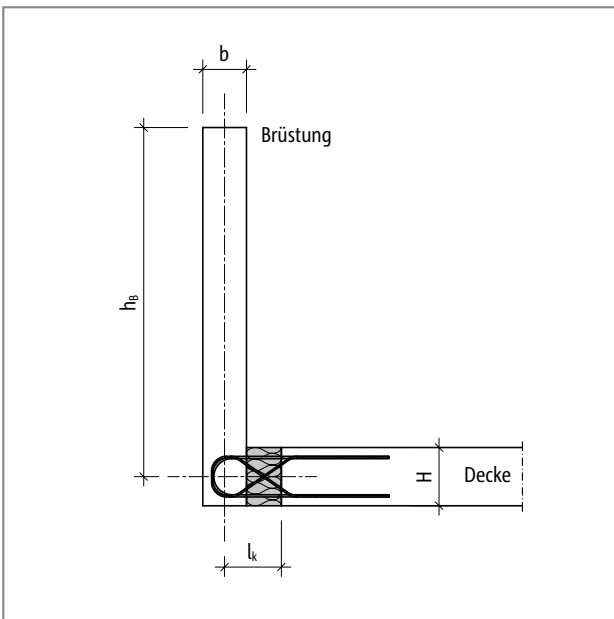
Schöck Isokorb® T Typ AP: Statisches System Brüstungshöhe  $h_A$
